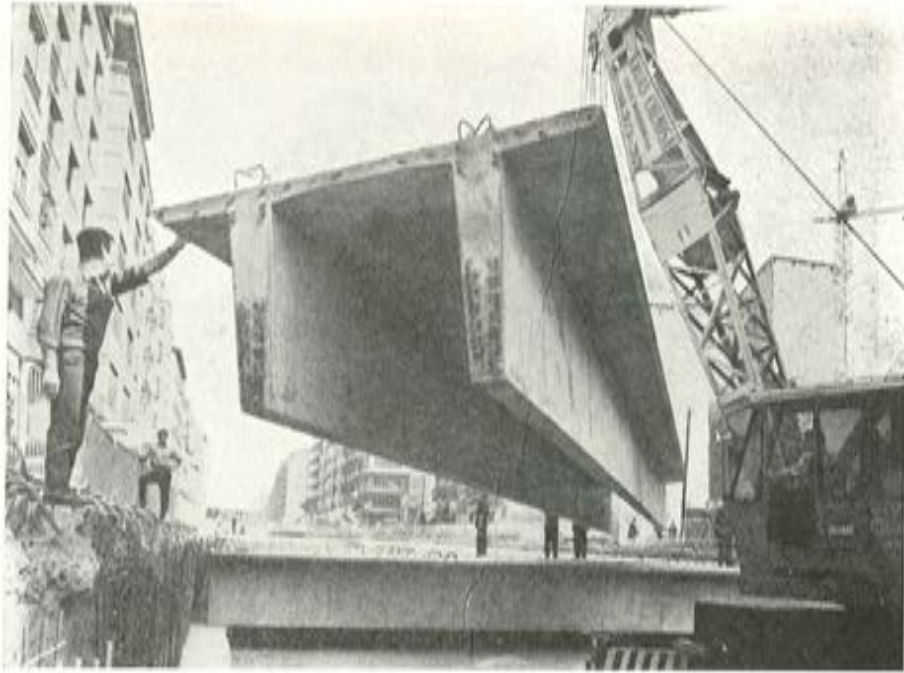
Transporte de paneles de hormigón pretensado para forjados de construcciones escolares.
